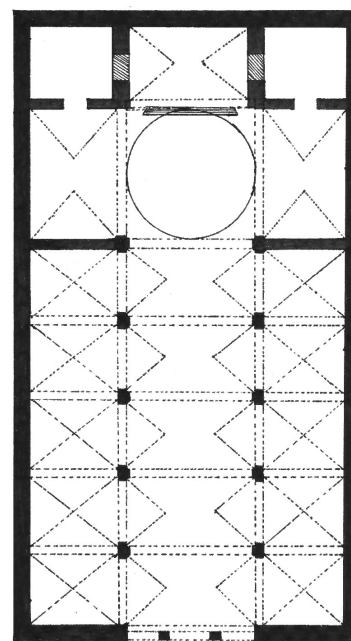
Lazcano. Convento de Santa Teresa. Iglesia. Planta
